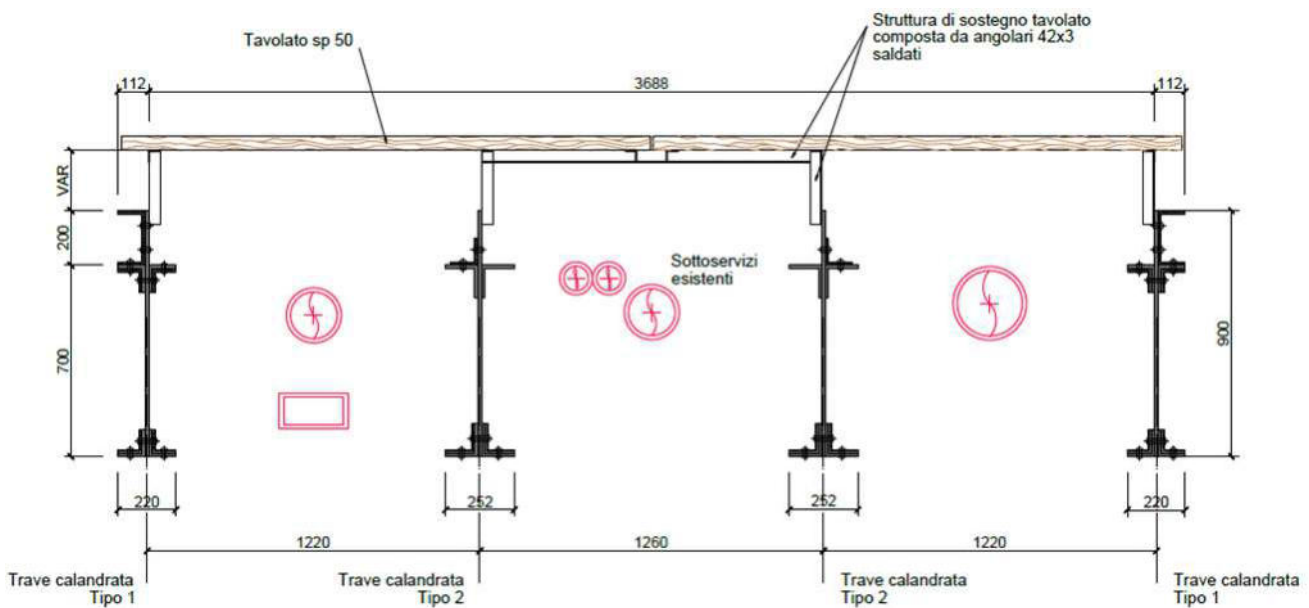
Sezione tipica dello stato di fatto con individuazione dei sottoservizi
